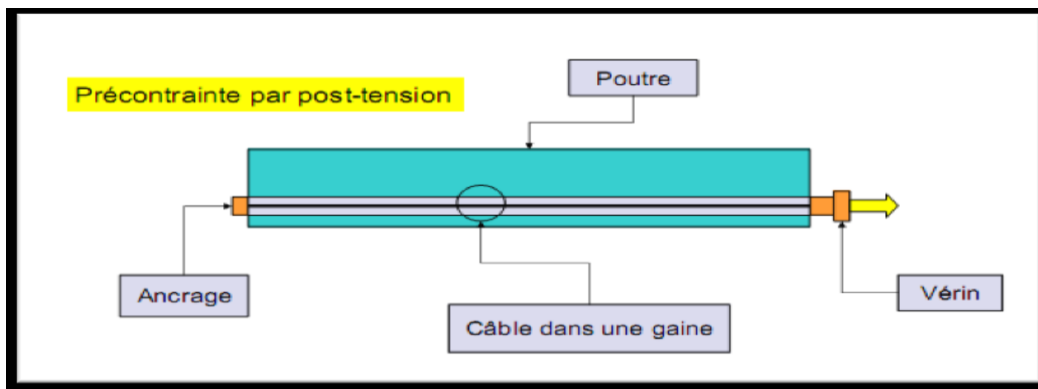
Coupe longitudinale d'une poutre en béton précontraint par post tension.
